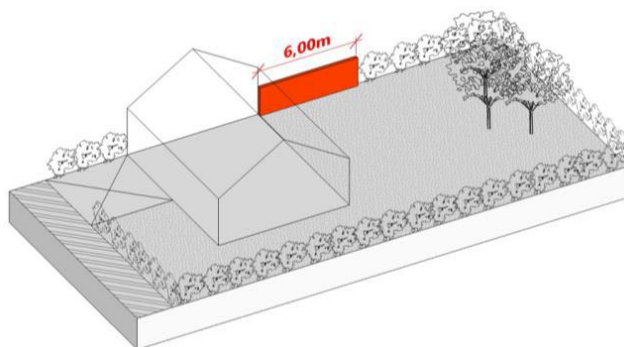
Schéma d'implantation du mur maçonné ou des panneaux occultants
